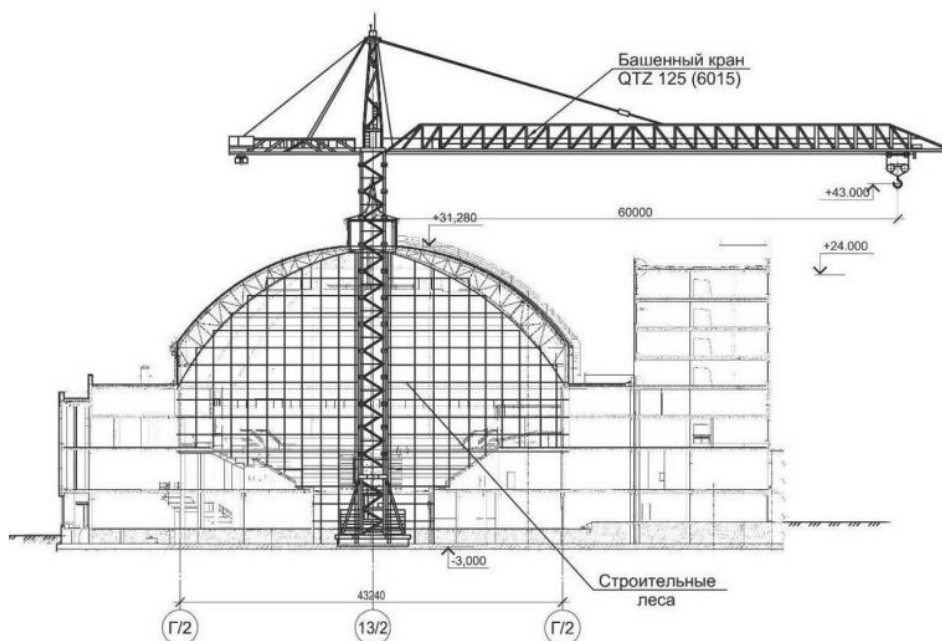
Вариант организации рабочего горизонта с помощью строительных лесов на всю высоту
